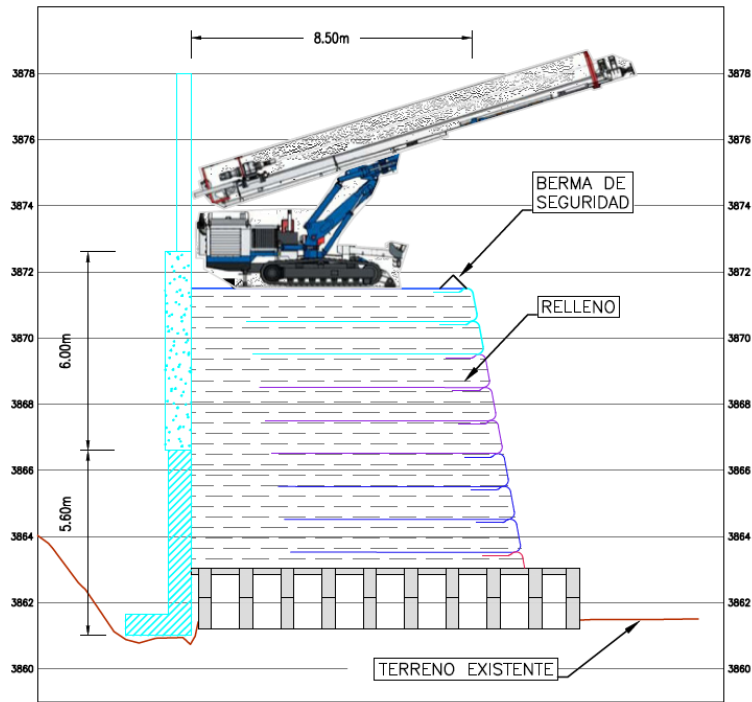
Seção transversal da plataforma de betão armado com aterro finalizado.
